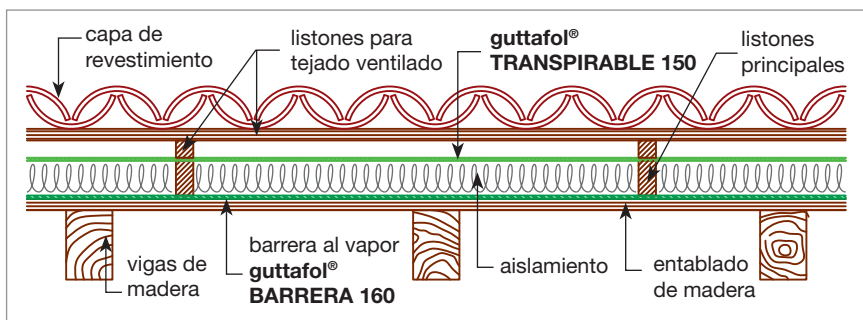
guttafol® TRANSPIRABLE 150 sobre el aislamiento con cámara de ventilación
